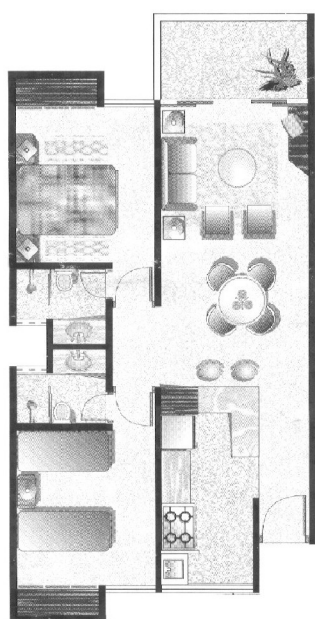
Planta do tipo 2.0/220, Residencial Stay House, Goiânia: duas suítes idênticas em formato e área
